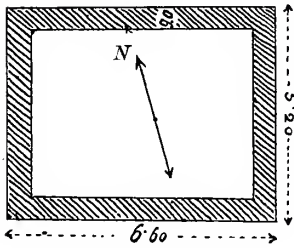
Grundriss eines römischen Gebäudes.
